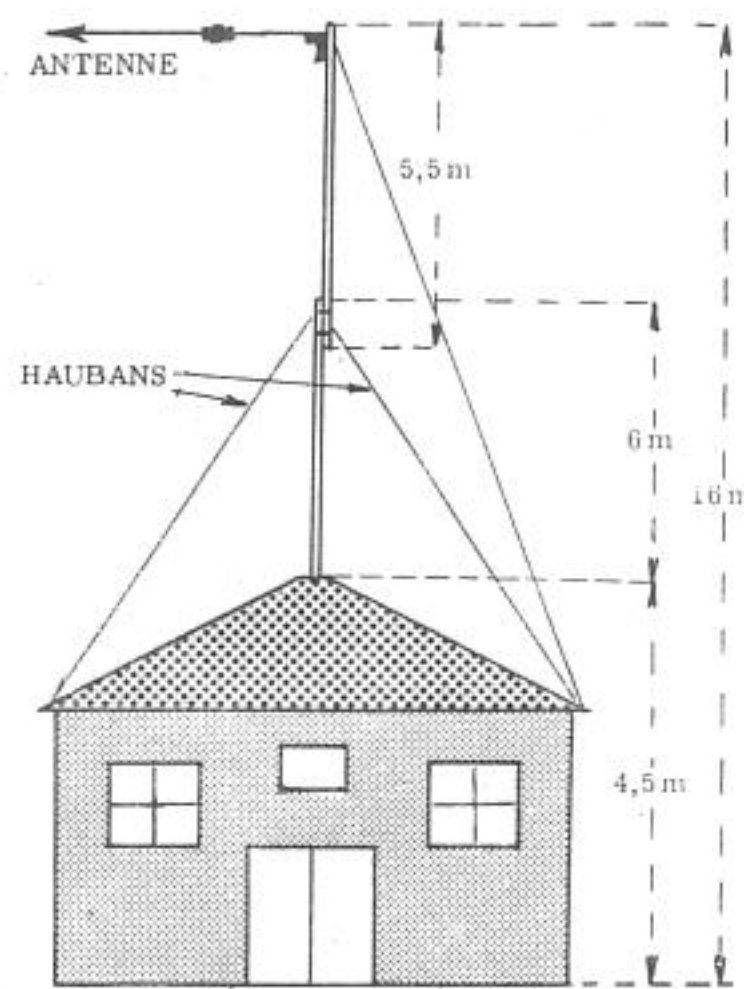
Installation d'un support sur le toit d'une construction de hauteur limitée. La portion inférieure est maintenue au moyen de quatre haubans et la portion supérieure, au moyen, de 2 seulement, installés de façon à équilibrer la traction exercée par l'antenne. De cette façon on peut atteindre des hauteurs relativement élevées.
